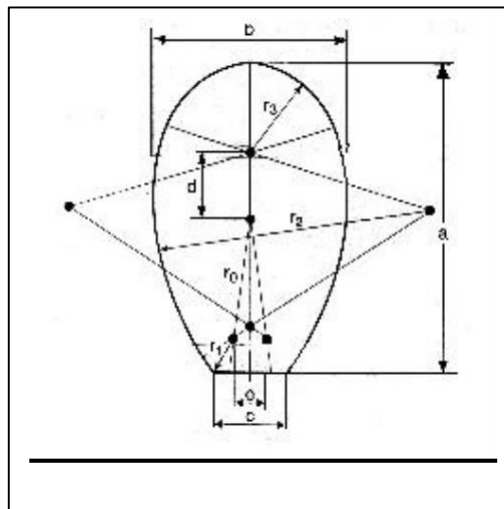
Coupe type d'un tuyau ovoïde préfabriqué
